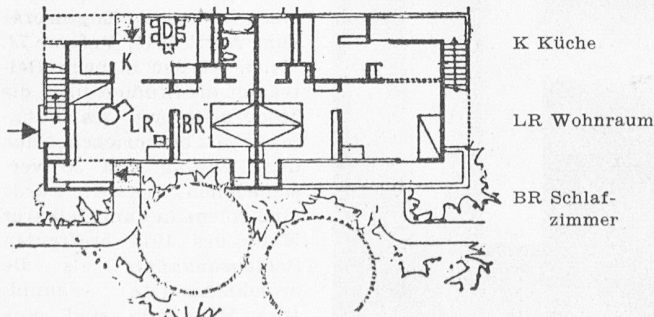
Zweistöckiges Doppelhaus mit vier Zweizimmerwohnungen; obere Wohnung mit Ausstertrepp. — 1:300
